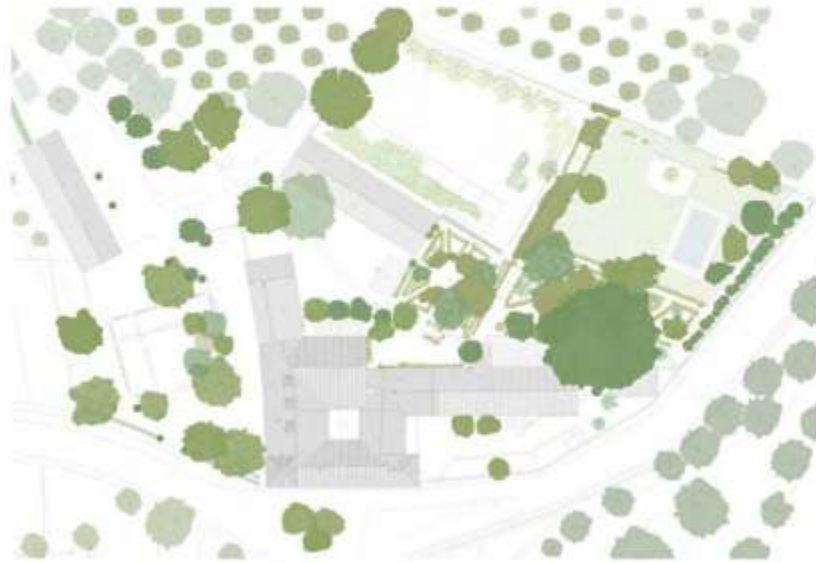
Planta de cubiertas del recinto con huerta y jardines.
